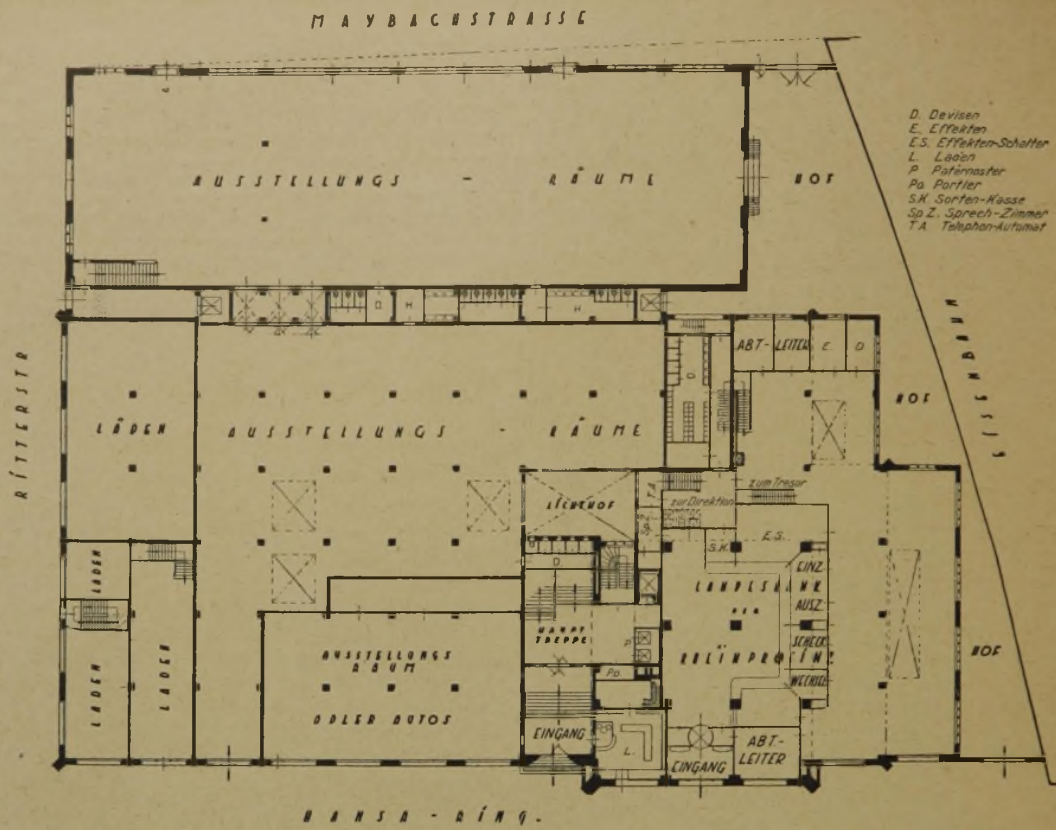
(oben). Erdgeschoss-Grundriß. Abb. 3 (unten). Keller-Grundriß. (1:600).
